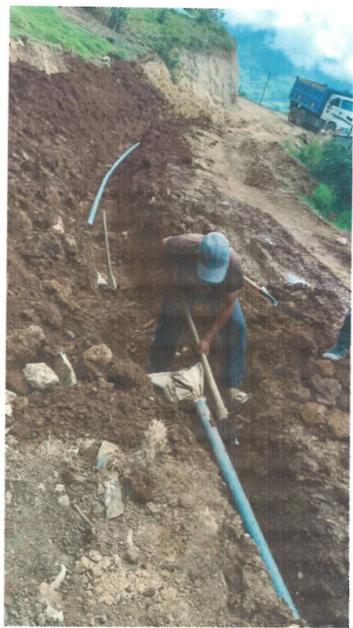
Enterrando tubería paralela a la cuneta en otro sector
